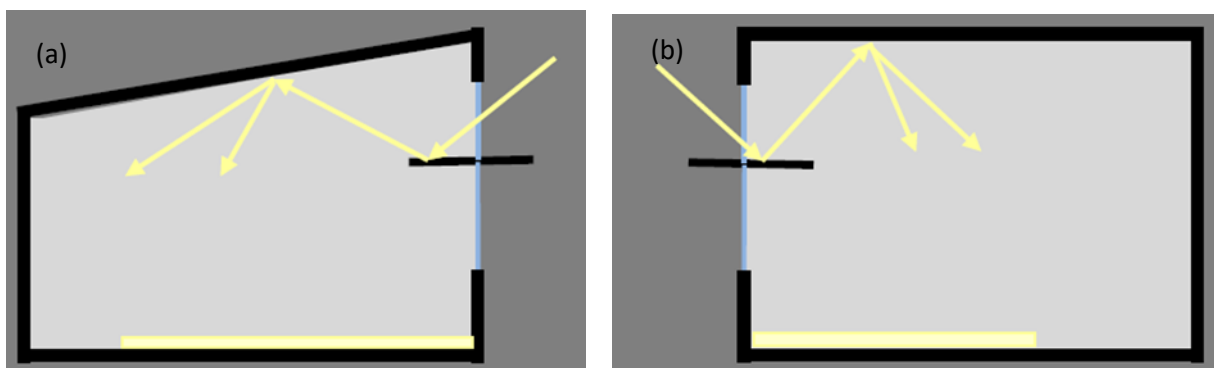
(a) : un light shelf avec un plafond incliné, (b) : un light shelf avec un plafond droit.
